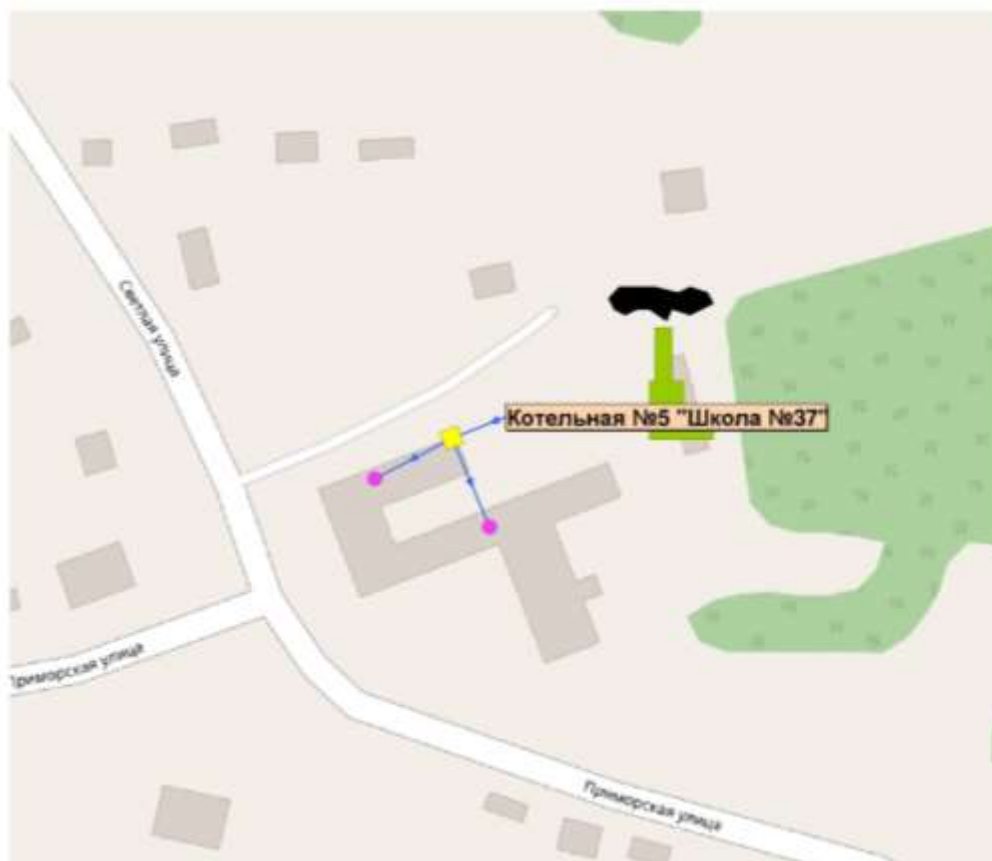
Схема тепловых сетей от котельной №5
